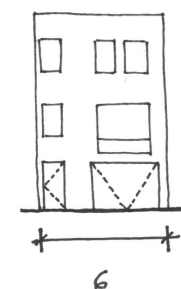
ESQUEMA DE UNA CASA TRADICIONAL CON APARCAMIENTO INTEGRADO EN LA CONSTRUCCIÓN, 1940.
